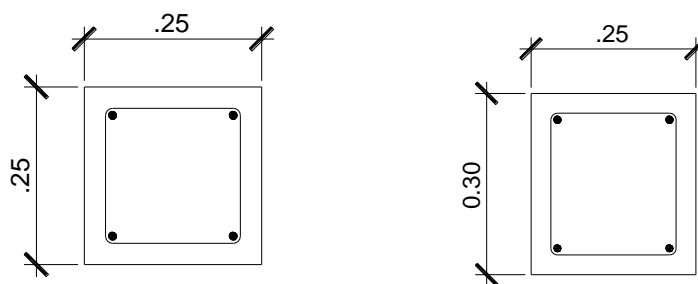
Secciones transversales típicas de los elementos estructurales, columnas y vigas. Fuente: Elaboración propia.
